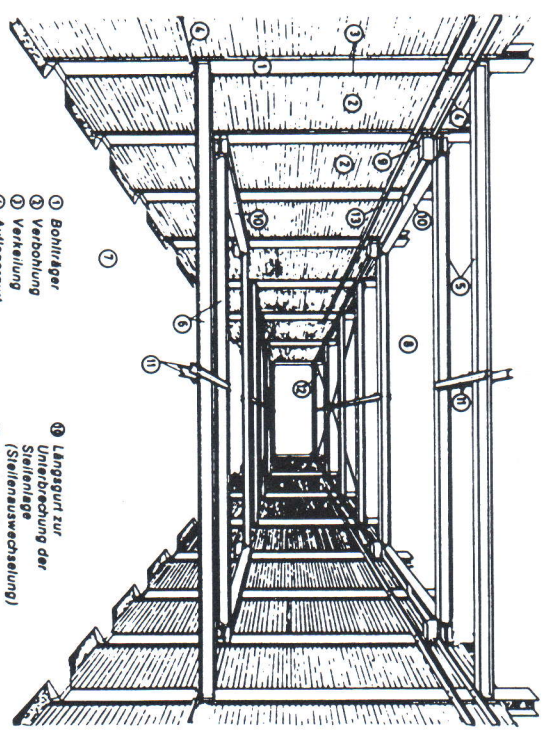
Gesamtansicht einer Baugruben mit Trägerbohlwänden nach [6]
